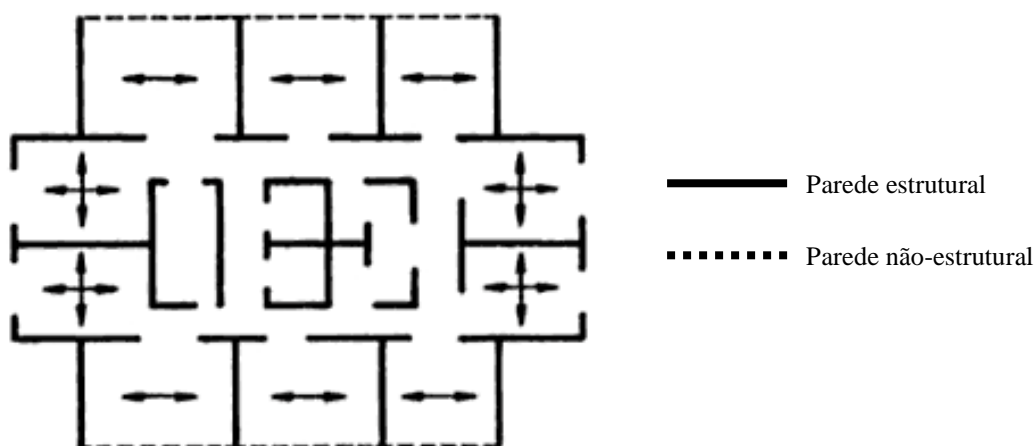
Sistema de paredes complexo. Fonte: HENDRY, 1981.
